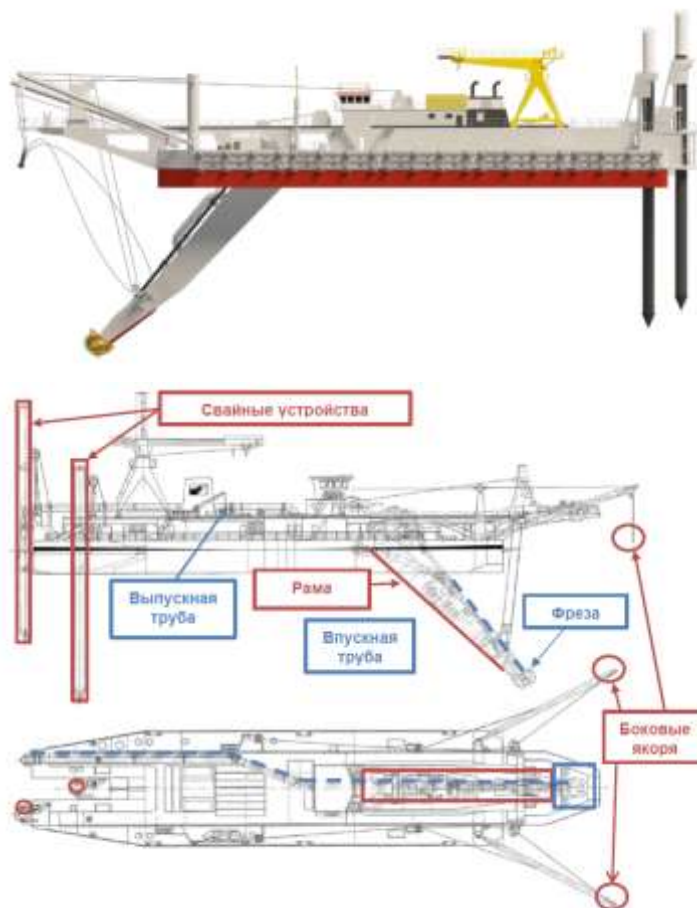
Фрезерный земснаряд, вид сбоку и сверху
